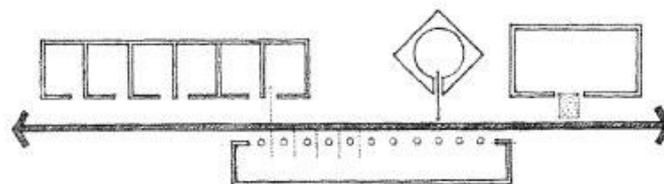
Ruang yang dihubungkan oleh ruang bersama
